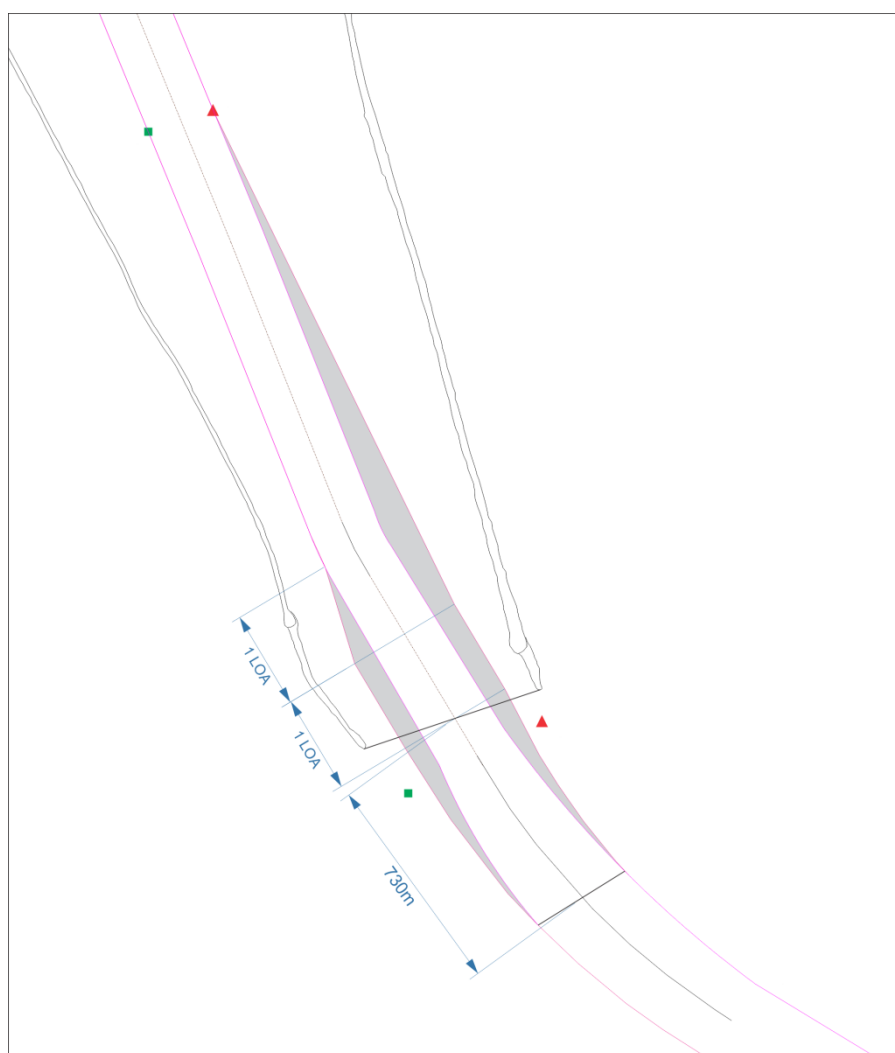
Dragagem sugerida para a entrada do canal – Vista de topo
